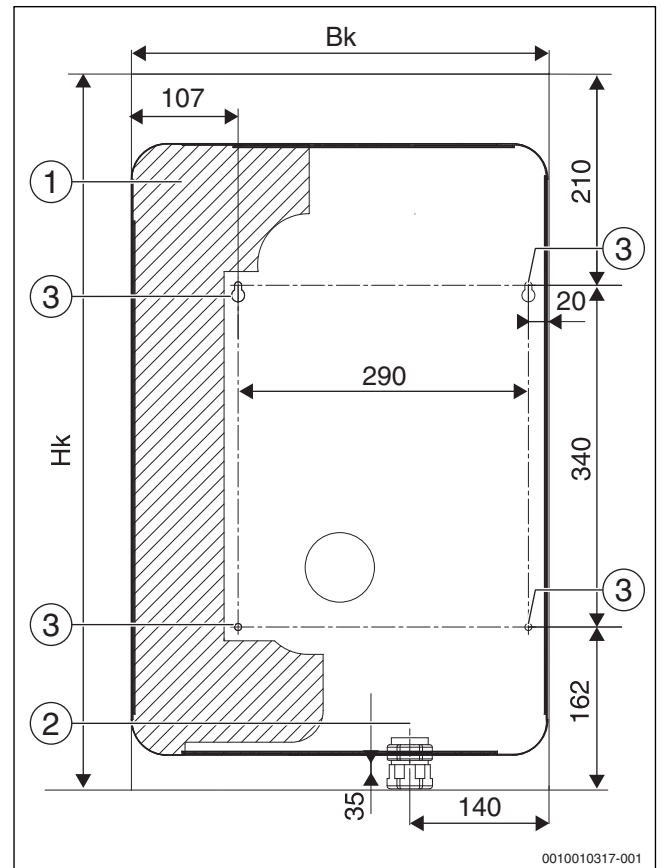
Abmessungen der Bohrungen für das Befestigen des Heizkessels an der Wand und für das Versorgungskabel beim Heizkessel Tronic Heat 3500 15-24 kW
